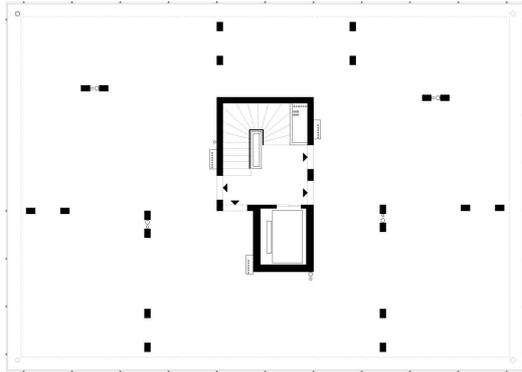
Grundriss 'Grundbau und Siedler' bei Übergabe an Siedler
